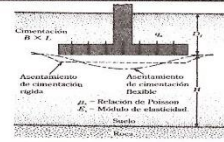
Asentamiento elástico de cimentaciones flexibles y rígidas
